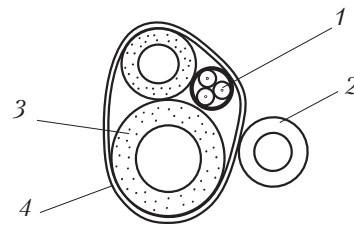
Теплоизоляция фреоновых трубопроводов:
